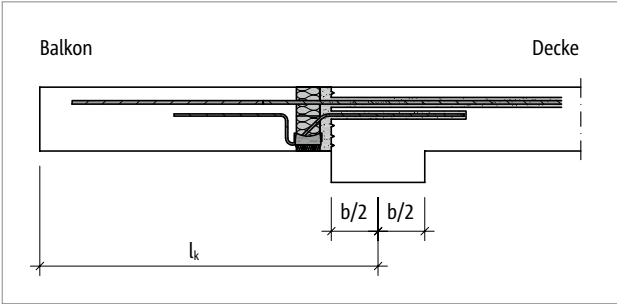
Schöck Isokorb® RT Typ K: Statisches System; indirekte Lagerung
